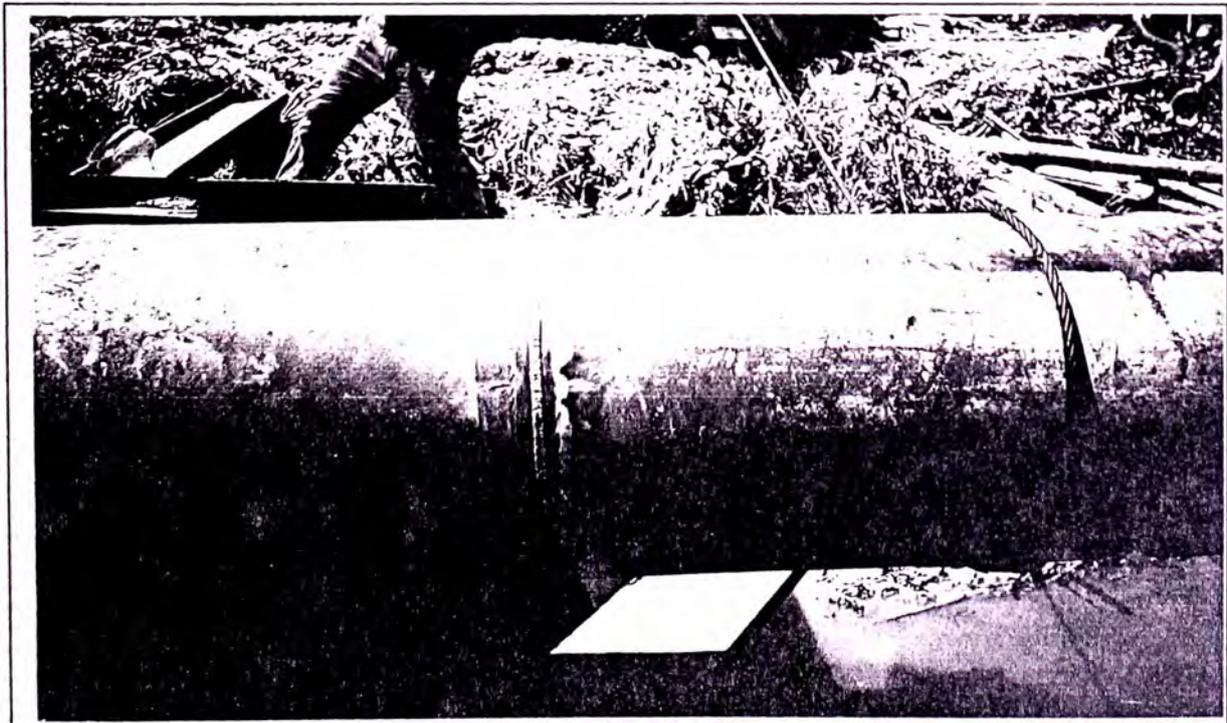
Cordón de soldadura en la unión de la margen derecha.
